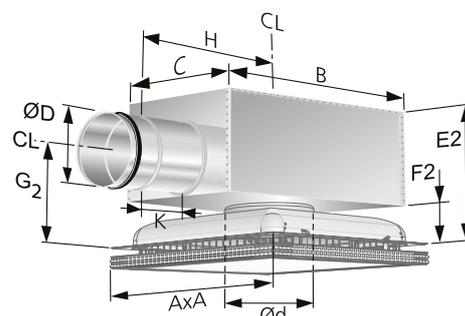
Dimensions, PELICAN Ceiling faible avec ALS faible.
